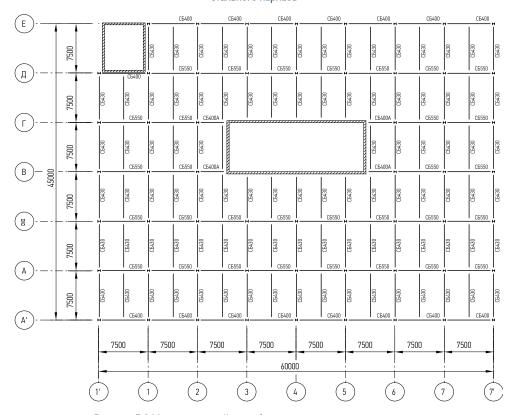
Маркировочный план балок перекрытия первого этажа для короткопролетной схемы стального каркаса
